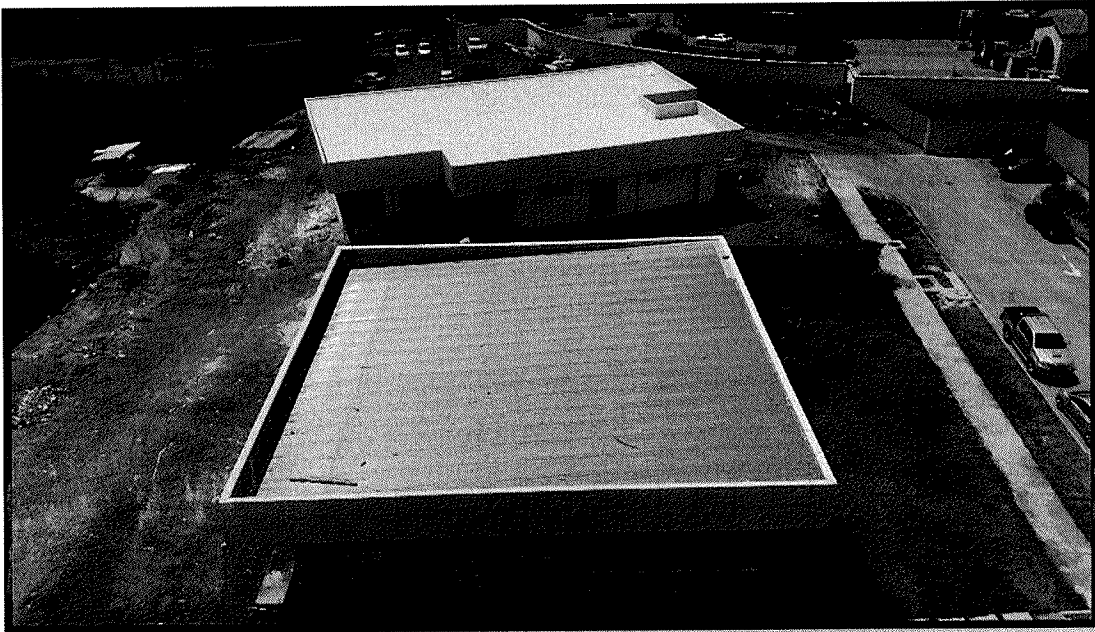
Terrenos en donde se construirá las edificaciones faltantes, actualmente están las oficinas de la promotora de los edificios.
